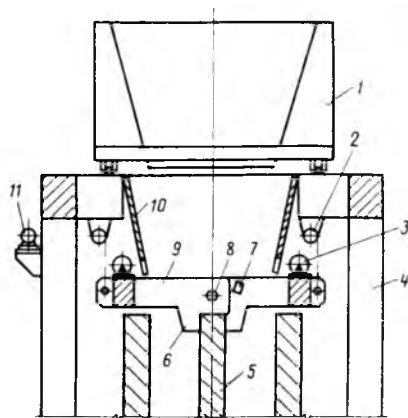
Вибронасадка для уплотнения бетонной смеси
